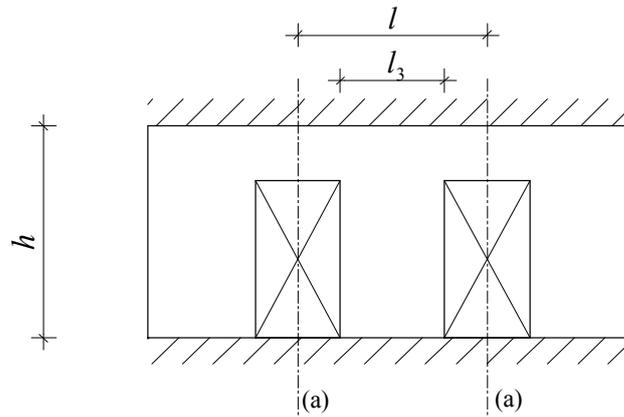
Mindestdicke und Grenzabmessungen von vertikal nicht beanspruchten Innenwänden mit begrenzter horizontaler Belastung
